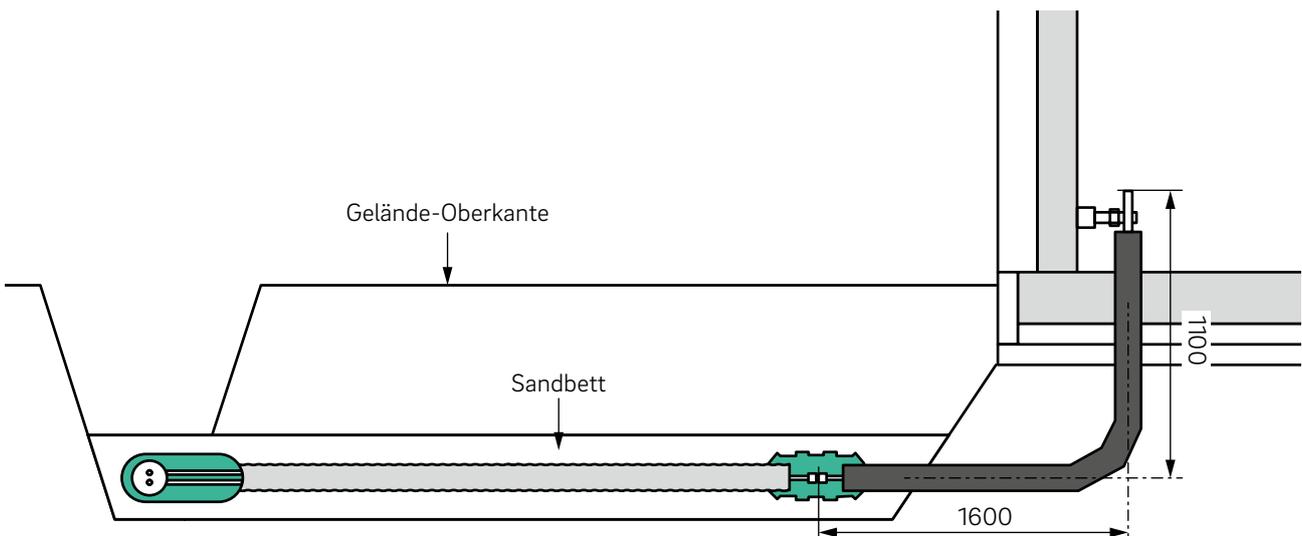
Abmessungen Hauseinführungsbogen (starr)
